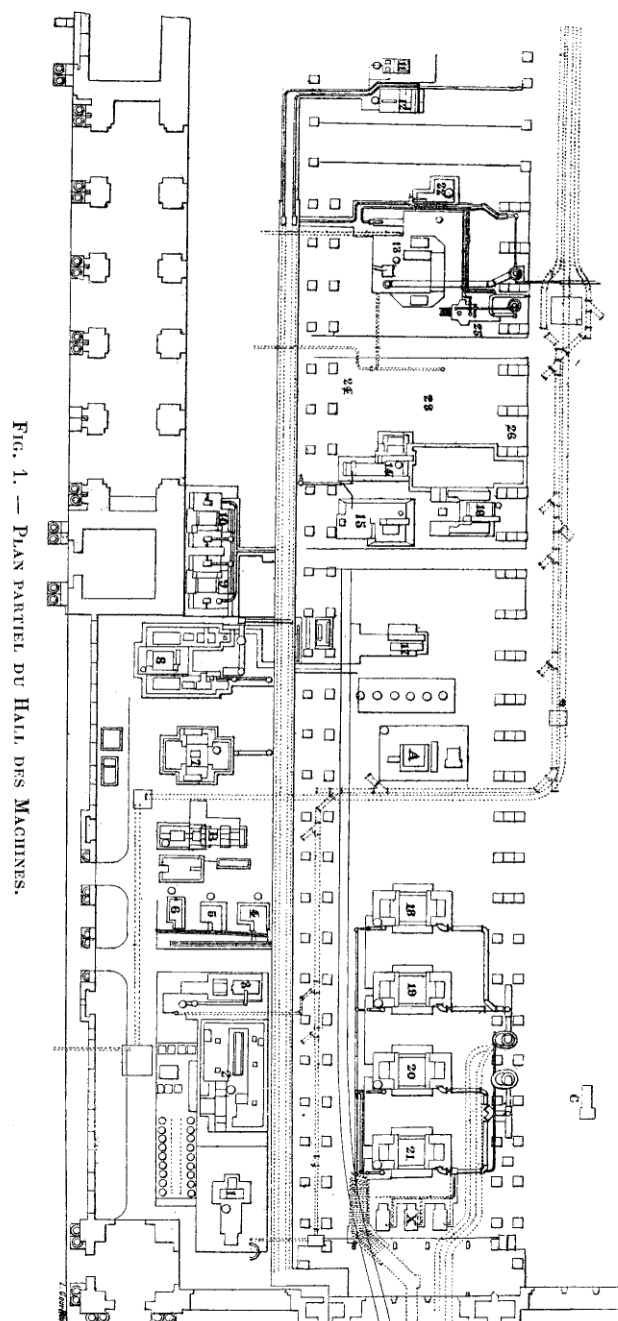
PLAN PARTIEL DU HALL DES MACHINES.
